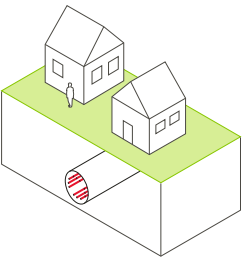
Pose des conduits de protection de câbles du projet Bezau—Birr
